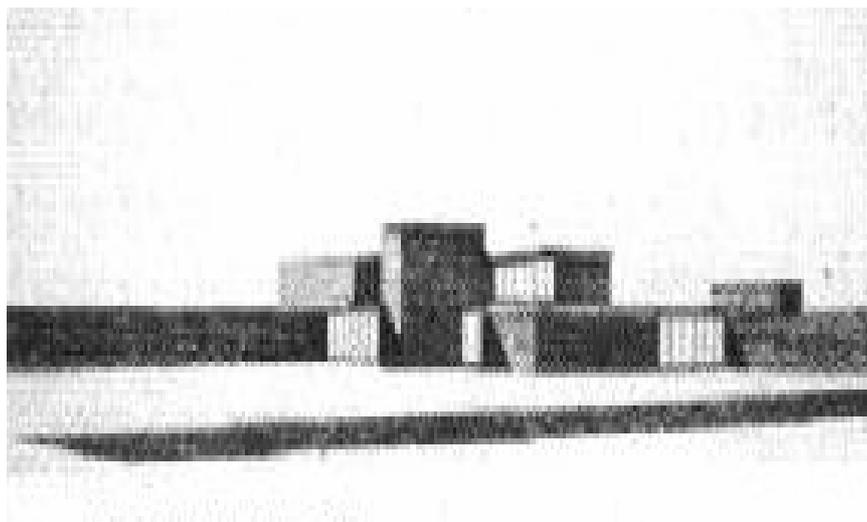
/ MIES VAN DER ROHE (1923) PROYECTO BRICK CONTRY HOUSE – FACHADA PRINCIPAL
